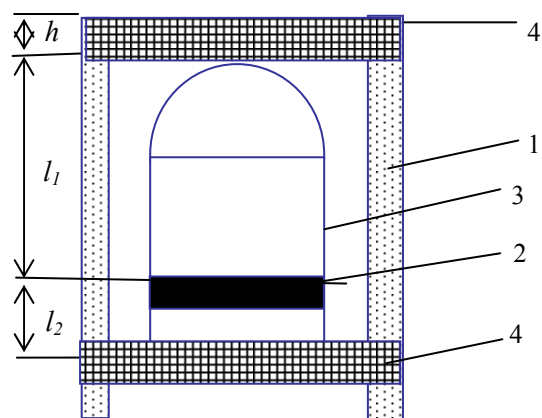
Креслення для закладки спряження ствола: 1 – контур кріплення ствола, 2 – вугільний пласт, 3 – контур перерізу спряження, 4 – залізобетонний пояс
